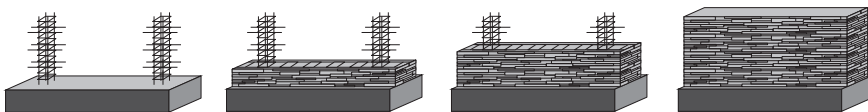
Каменная кладка с выпуском закладных стоек на стены
